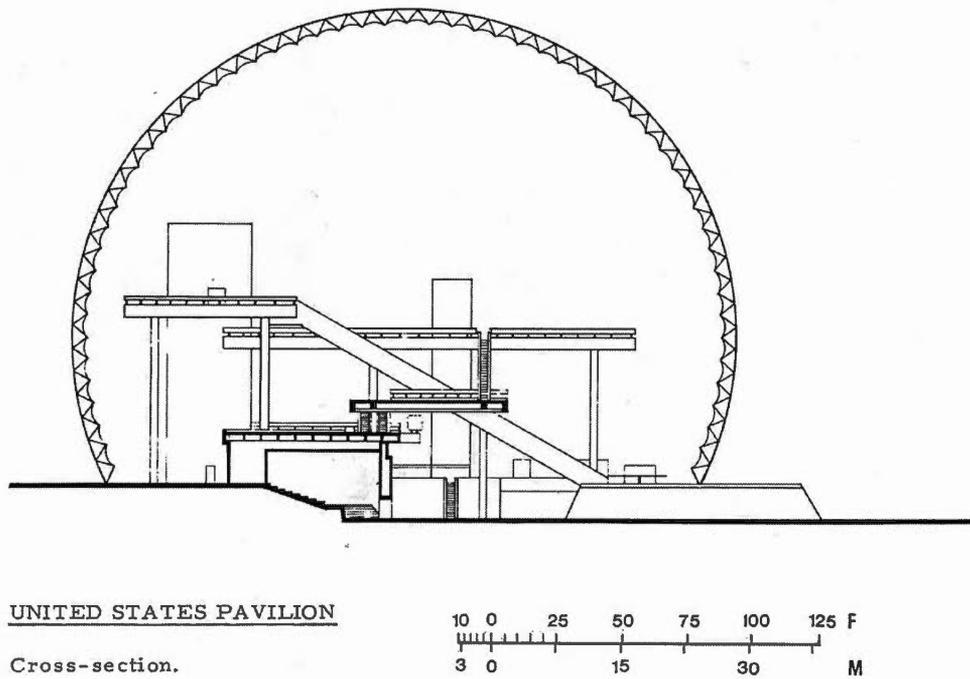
Coupe transversale à travers le pavillon des États-Unis
